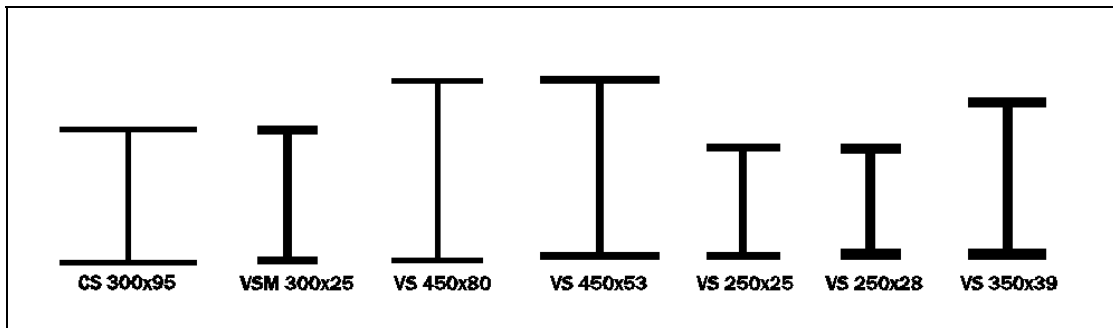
Verificação das seções de vigas e colunas utilizadas no projeto.
